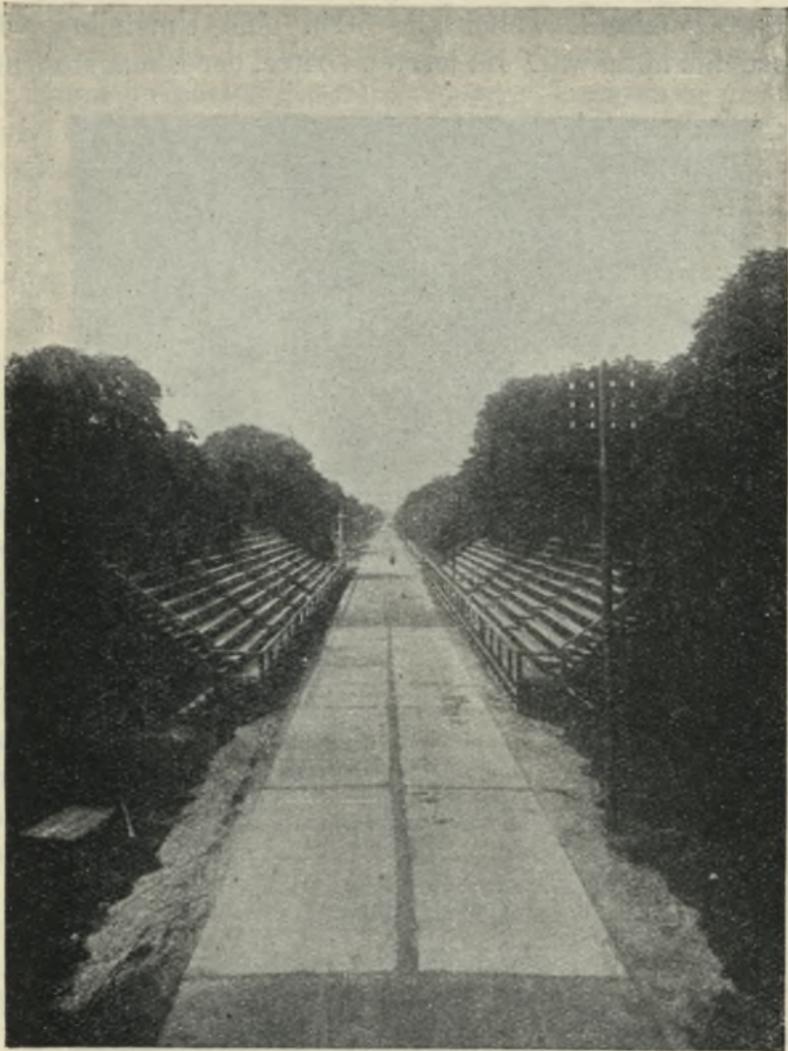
Betonversuchsstrecke im Forstenrieder Park bei München.
